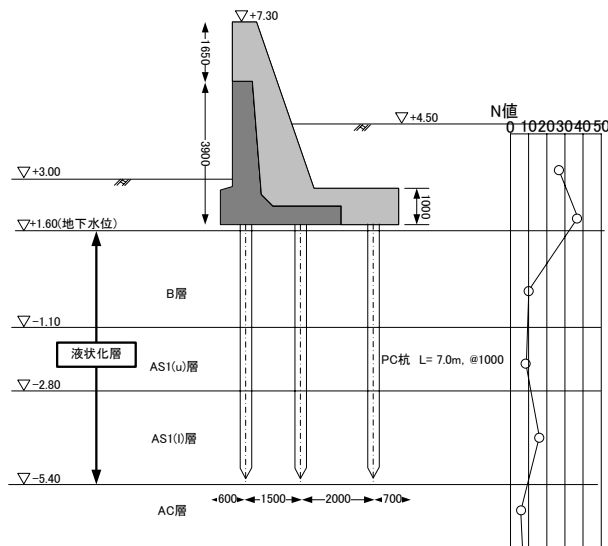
躯体と基礎杭の模式図 (単位 : mm)
